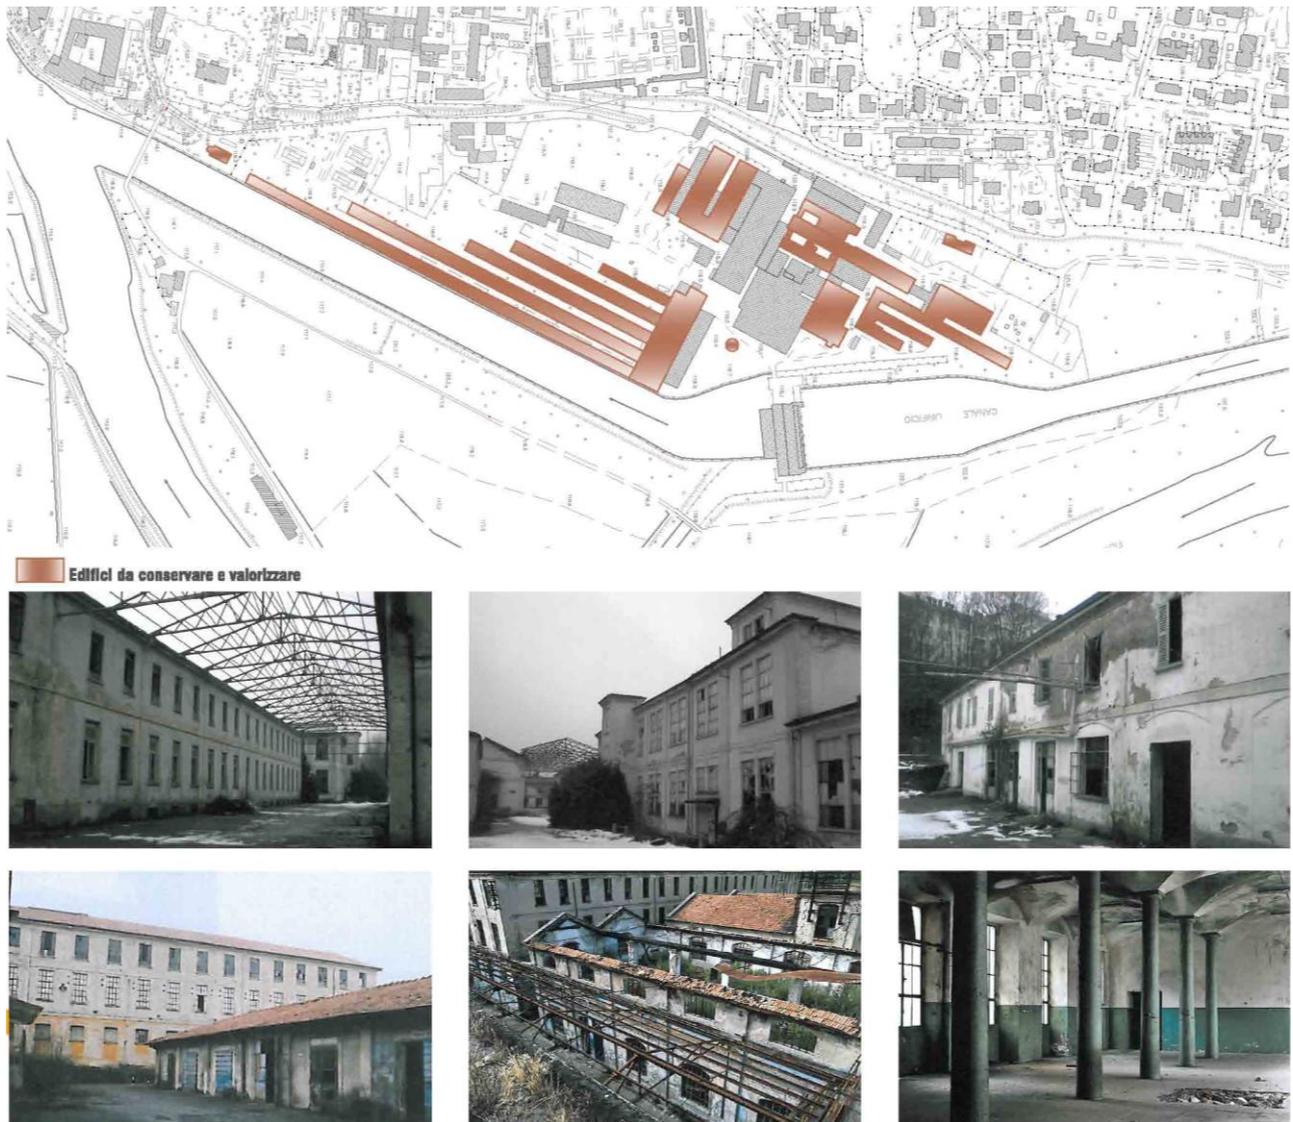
Edifici da conservare mediante recupero, restauro e restauro conservativo²⁶
